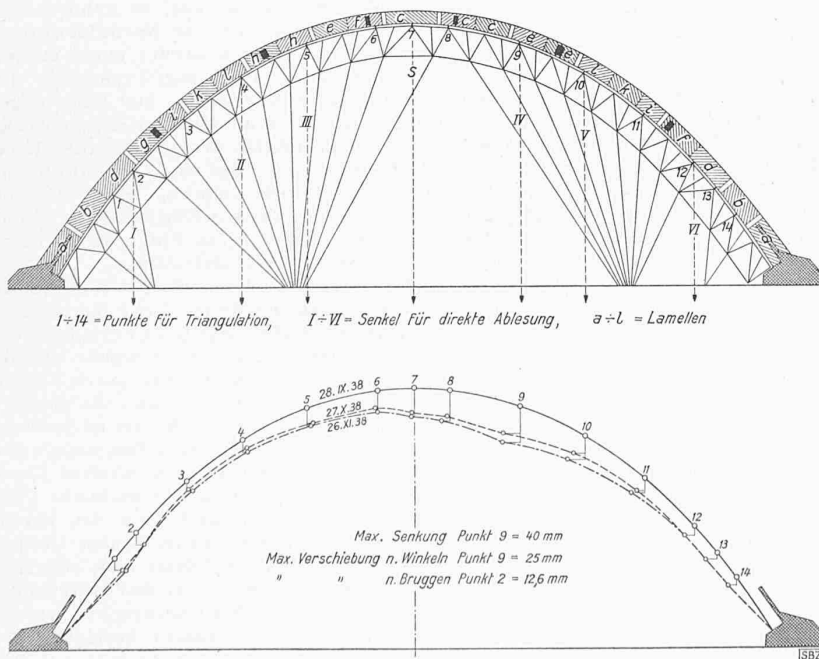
(links). Betoniervorgang, darunter Senkungen bis zur Entlastung des Lehrgerüsts
